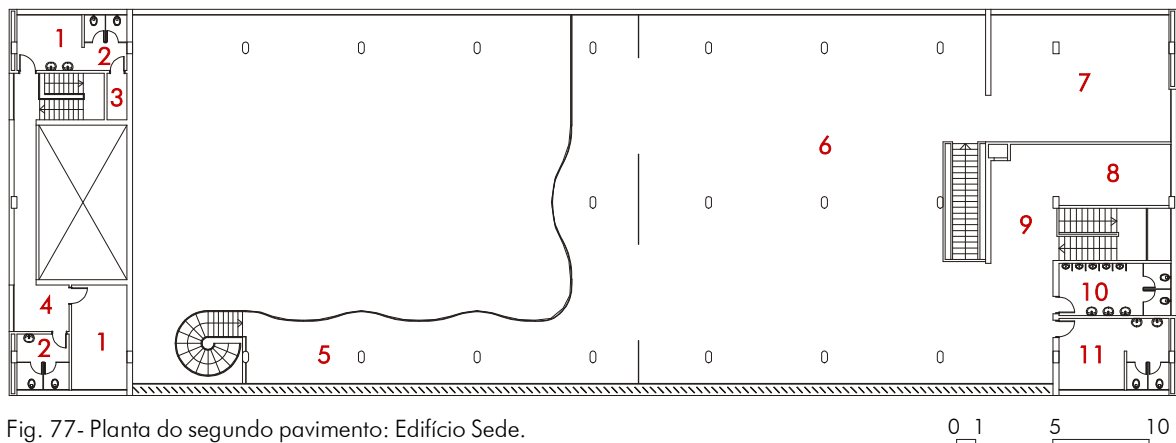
Planta do segundo pavimento: Edifício Sede.
